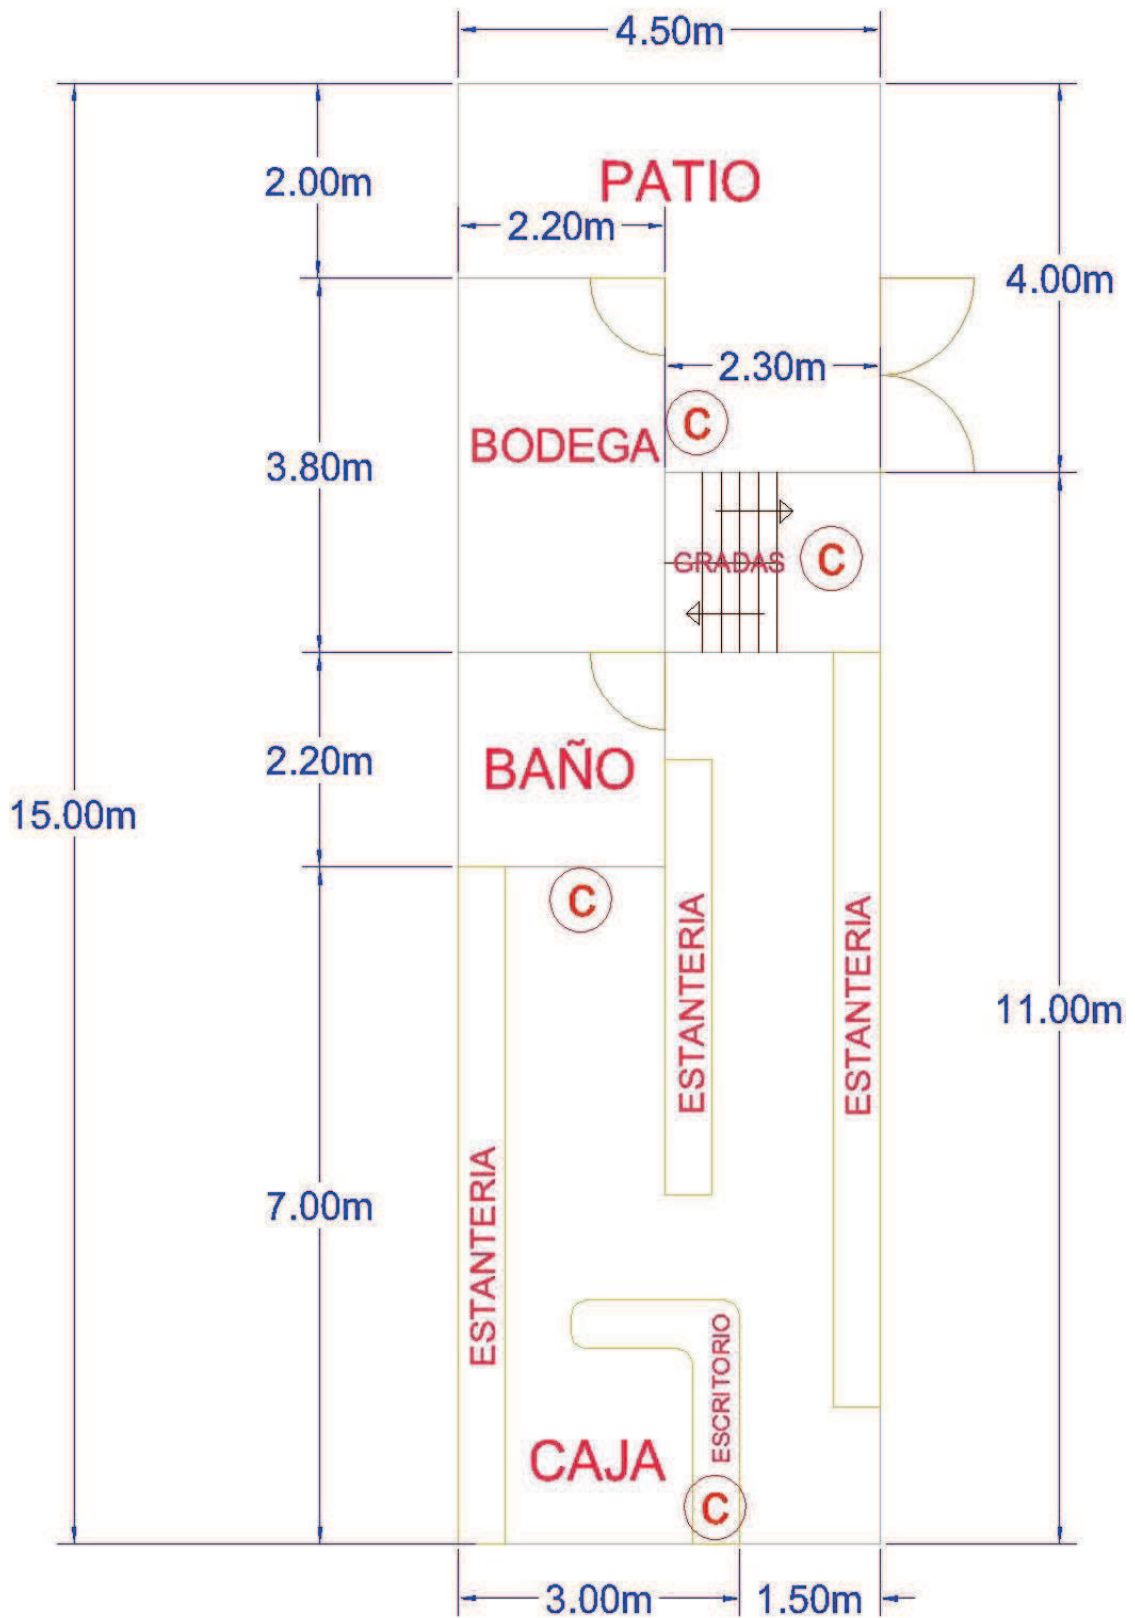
Localización de cámaras de seguridad en la planta baja del local
